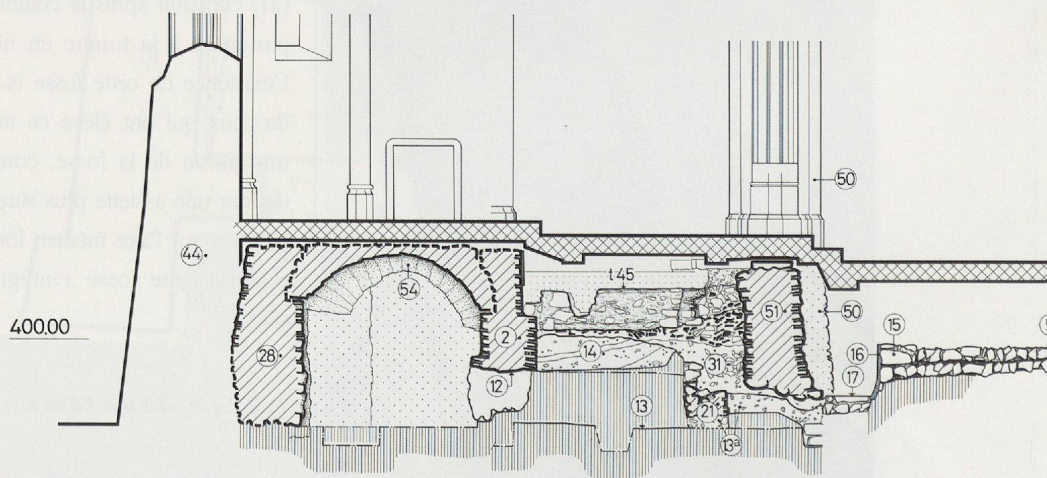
Coupe longitudinale, vue vers le sud. Echelle 1:100
